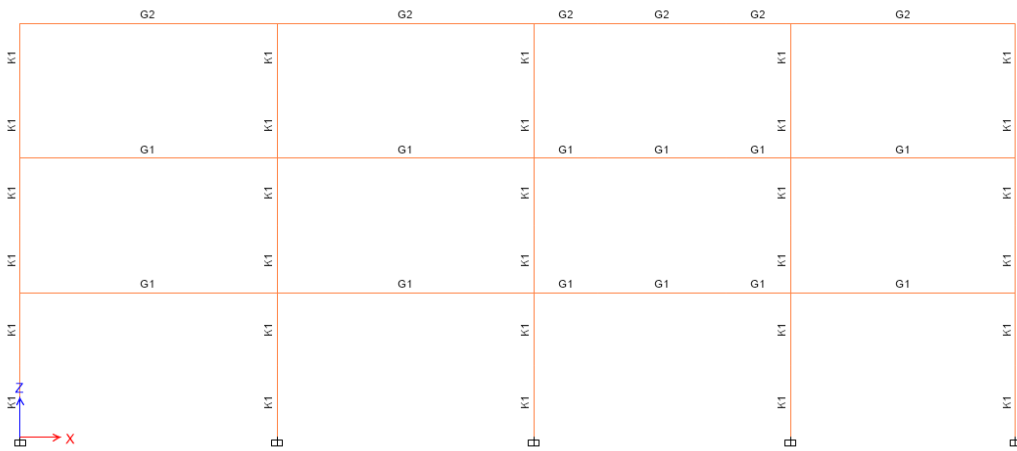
Tampak 3D Struktur Bangunan Beton Model 1 di Lapangan.
